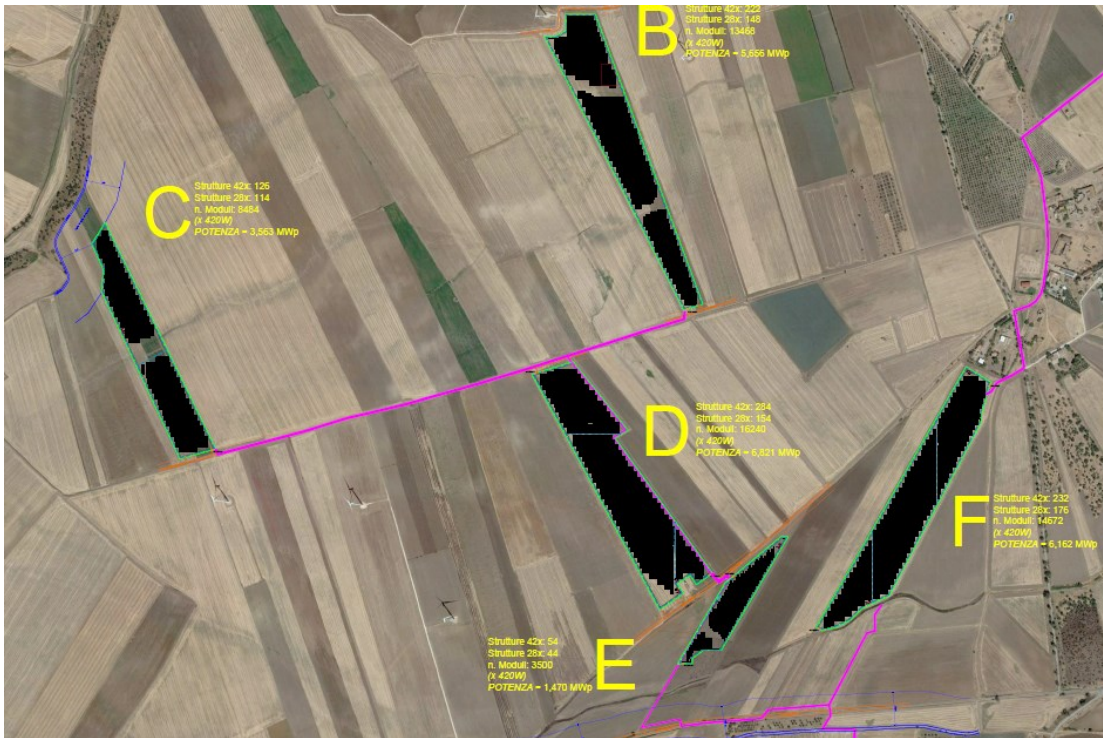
Layout di impianto dell’Area B-C-D-E e F
